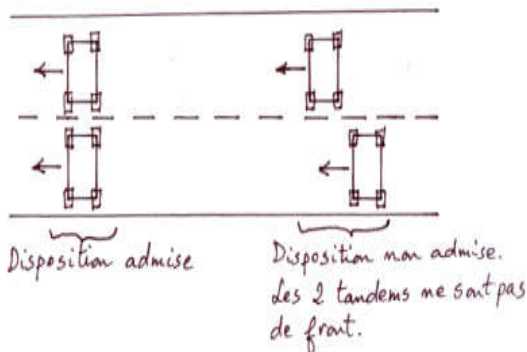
Dispositions en plan du système B₁ dans un pont droit
